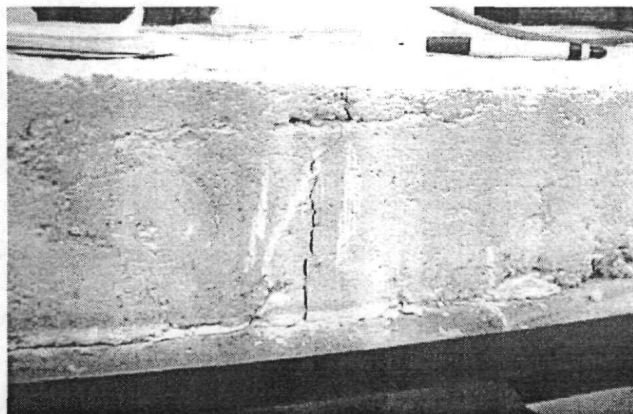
Agrietamiento por flexión sobre losa compuesta
